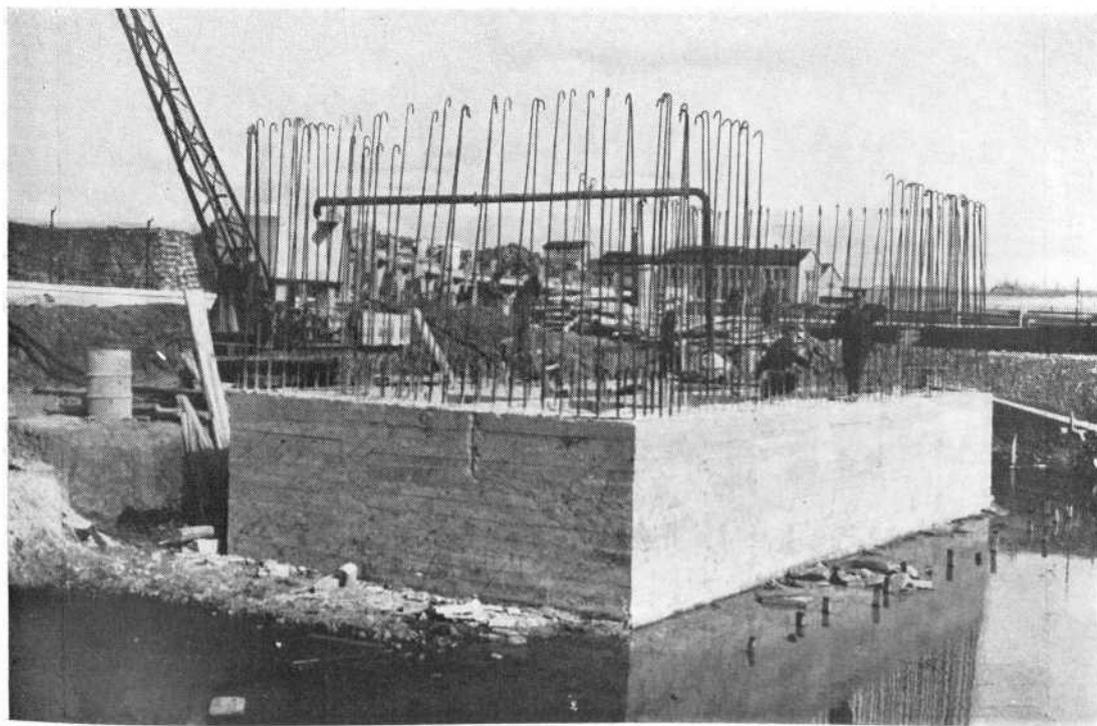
Cimentación del Silo de Burgos. Vista general del cajón indio.
